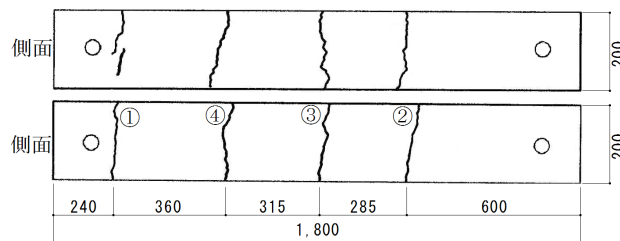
(a) ひび割れ状況 無対策(1-3)
